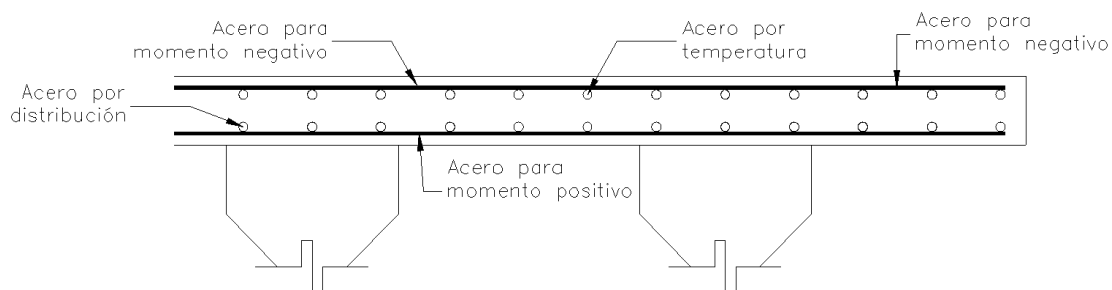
Ubicación del acero de refuerzo en losa intermedia y volado.
